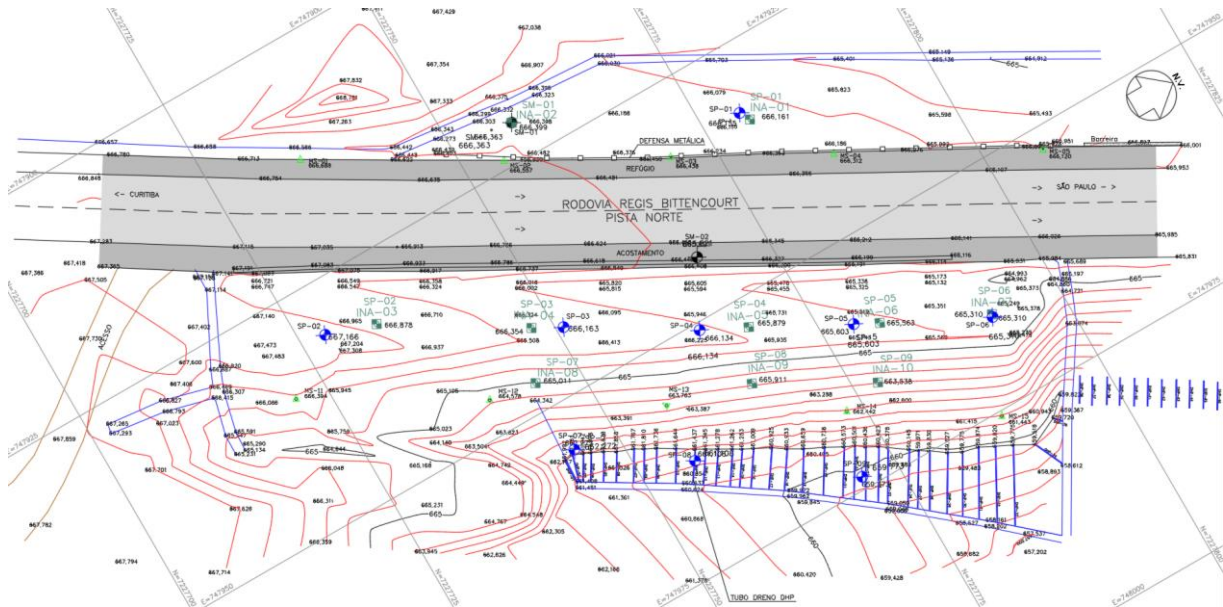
Planta de localização das sondagens à percussão e mistas do km 565+400
